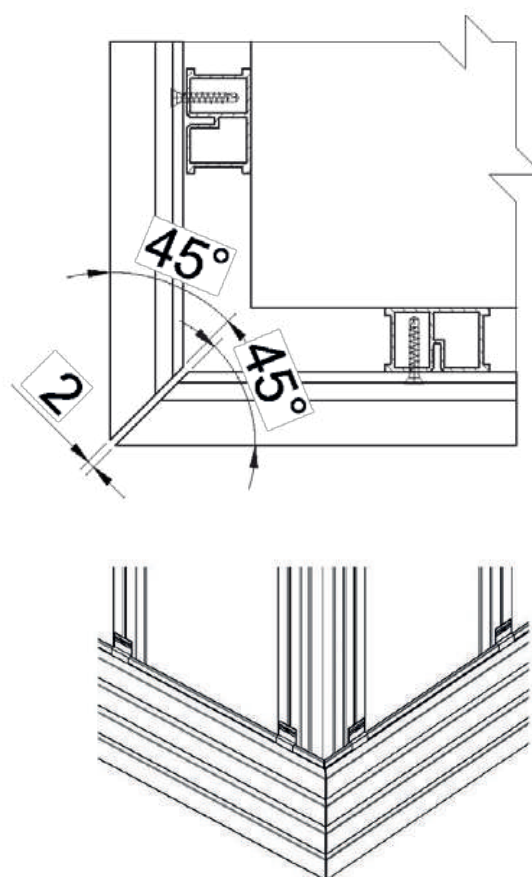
Instalación de la fachada en la esquina exterior del edificio
